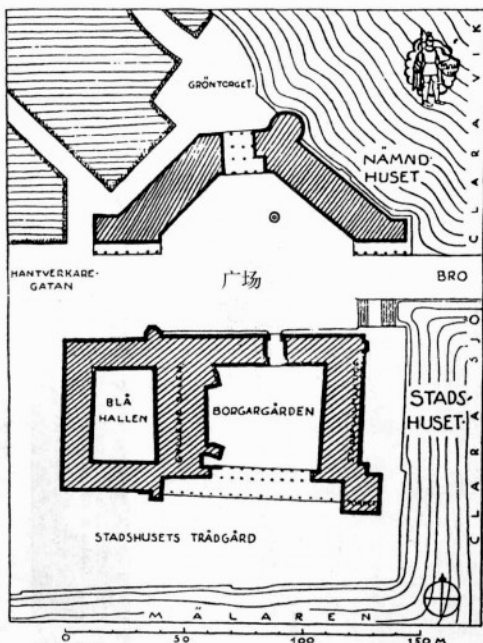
奥斯特贝克设计的瑞典斯德哥尔摩市政厅平面图
